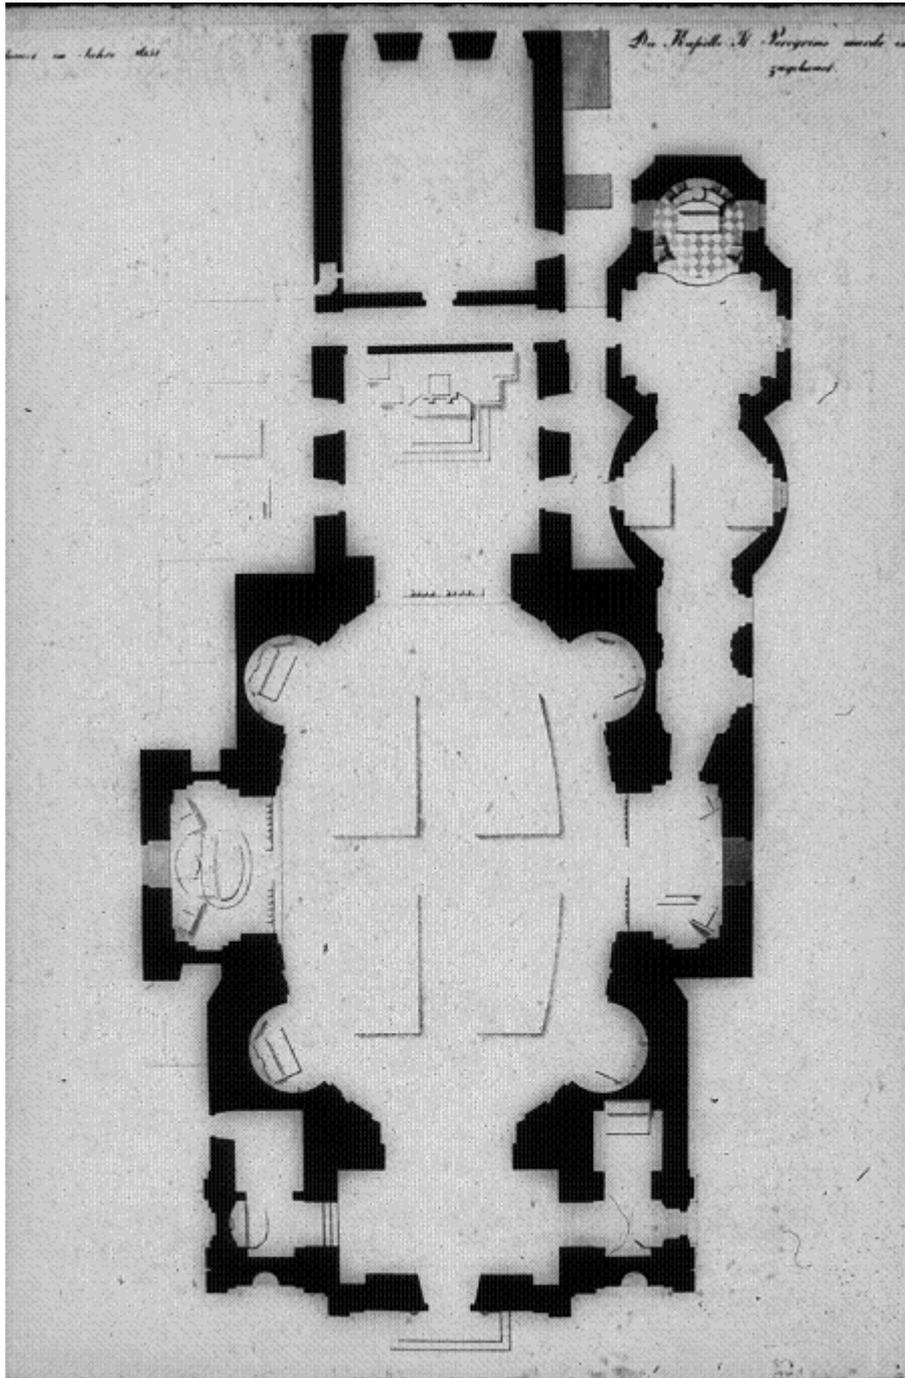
Wien, Servitenkirche, Grundriss
